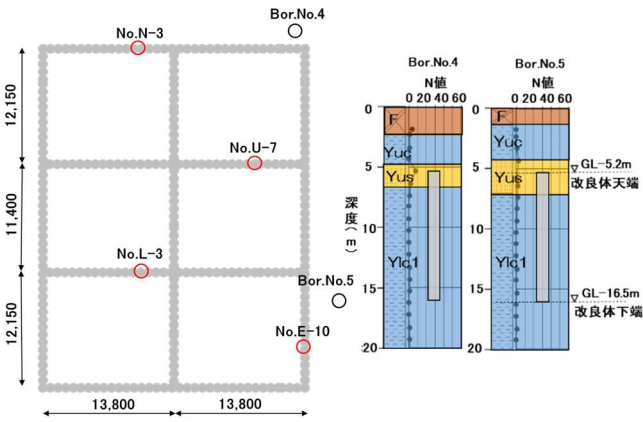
地盤改良体の平面配置 図-2 ボーリング柱状図
